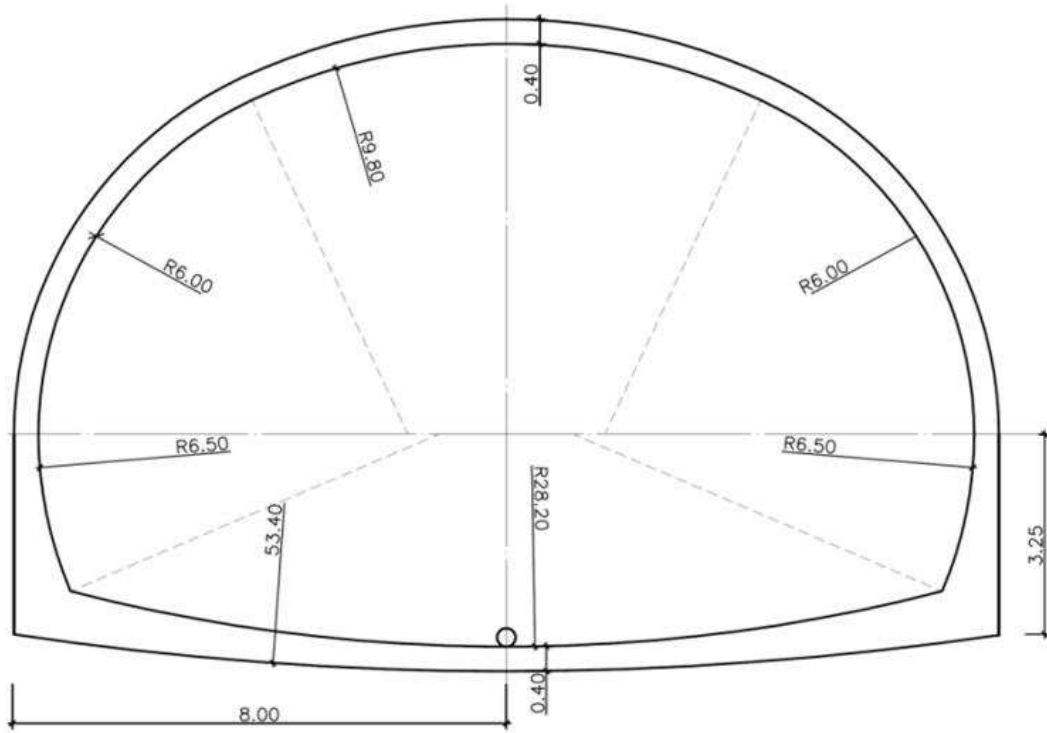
Secção Tipo 2 – medidas em metros (adaptado de Projecto de execução de túnel de Seixo alvo, COBA 2010).
